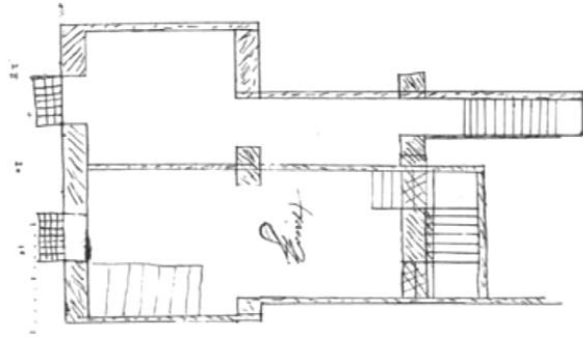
Plano original del sótano de una casa construida en 1616 en C/Carretas (González Redondo, 2007)
